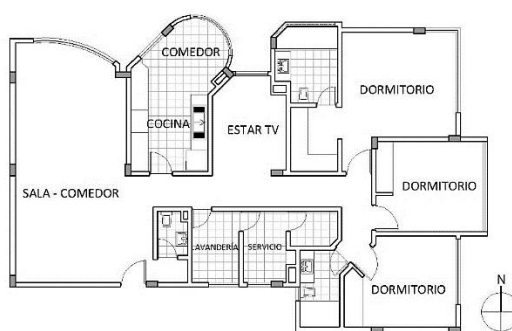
Planta arquitectónica. Viviendas 1 y 2
